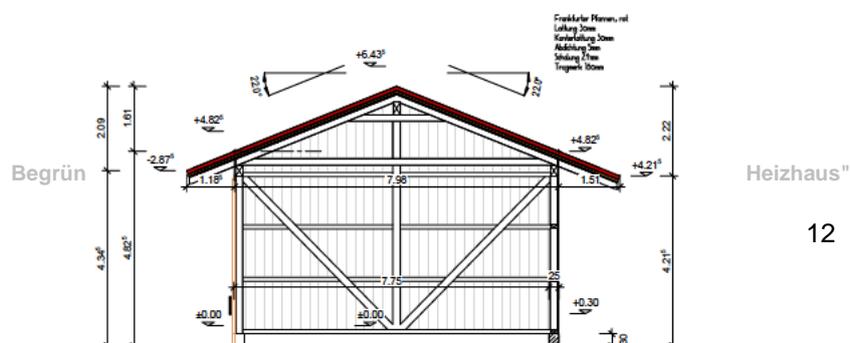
Schnitt Vereinestadel, Planstand: Eingabeplan 07.01.23
